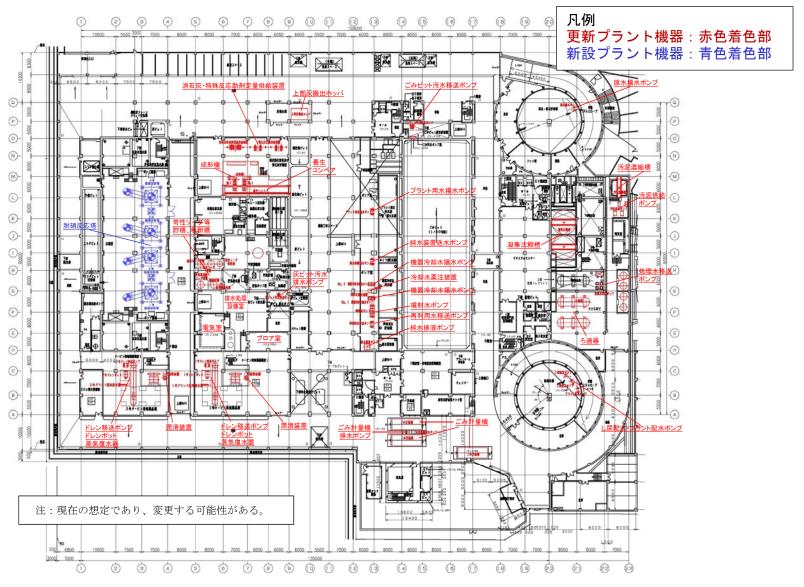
(1) 設備機器の更新箇所(1階平面図)
